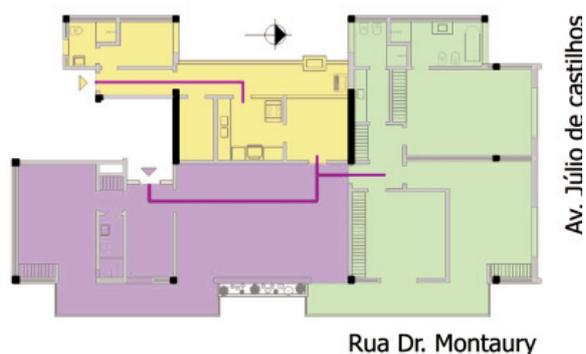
Planta Baixa do Ed. Solaris, indicando os acessos
